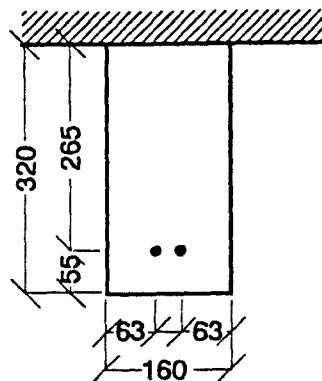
Abmessungen und Bewehrungsanordnung des Balkenquerschnitts
